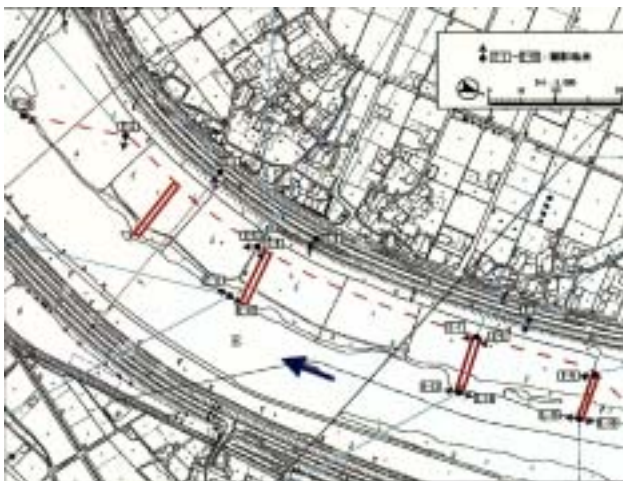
揖斐川 34.9km 地点の掘削箇所平面図
